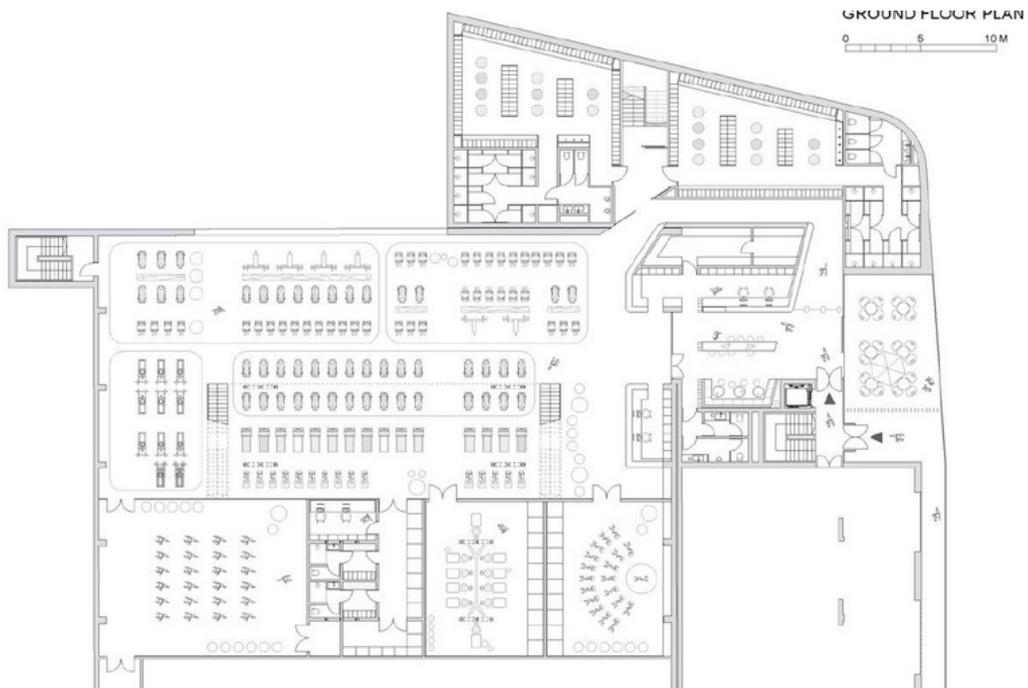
Planta baja arquitectónica, MFitnes. Fuente: ArchDaily, 2020
